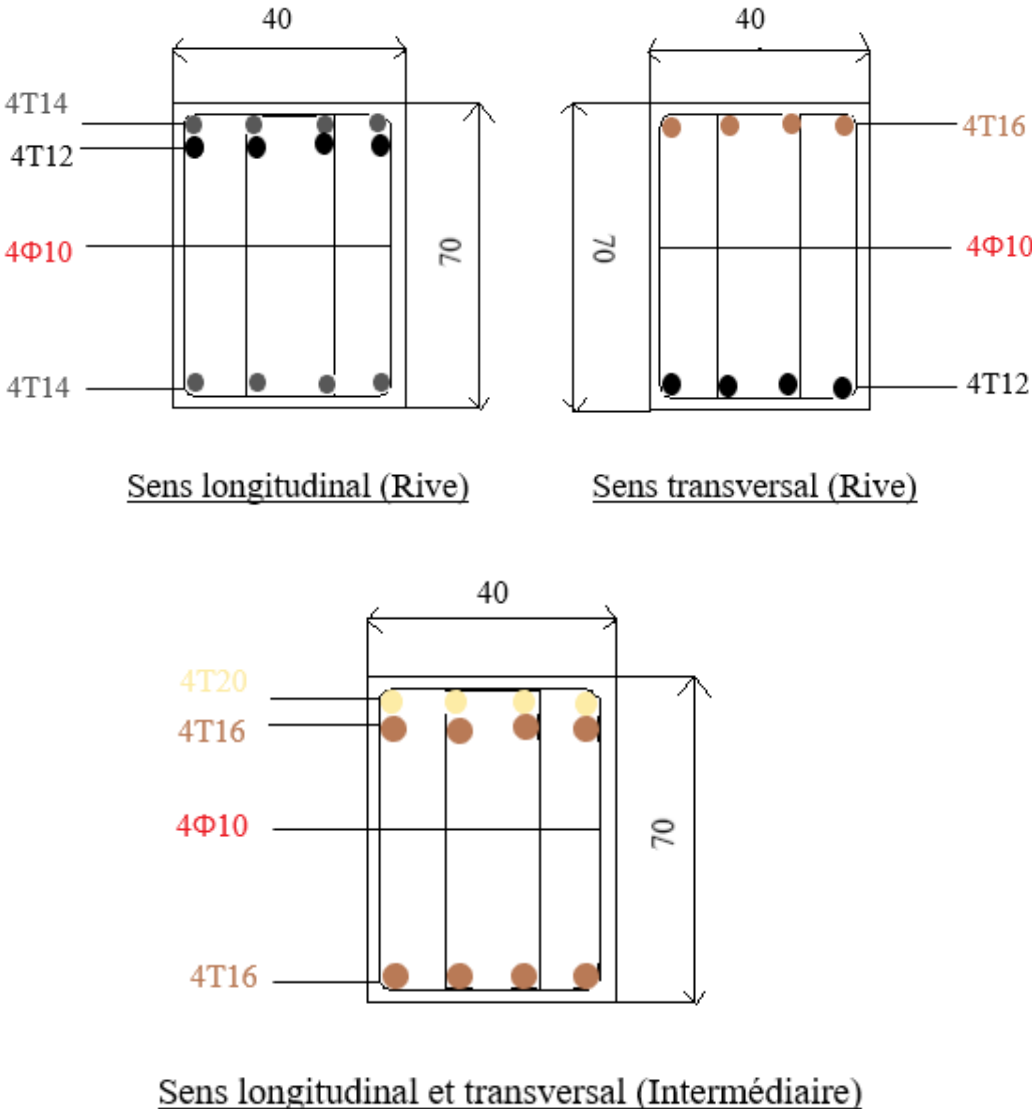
Disposition du ferrailage poutre de libage.
